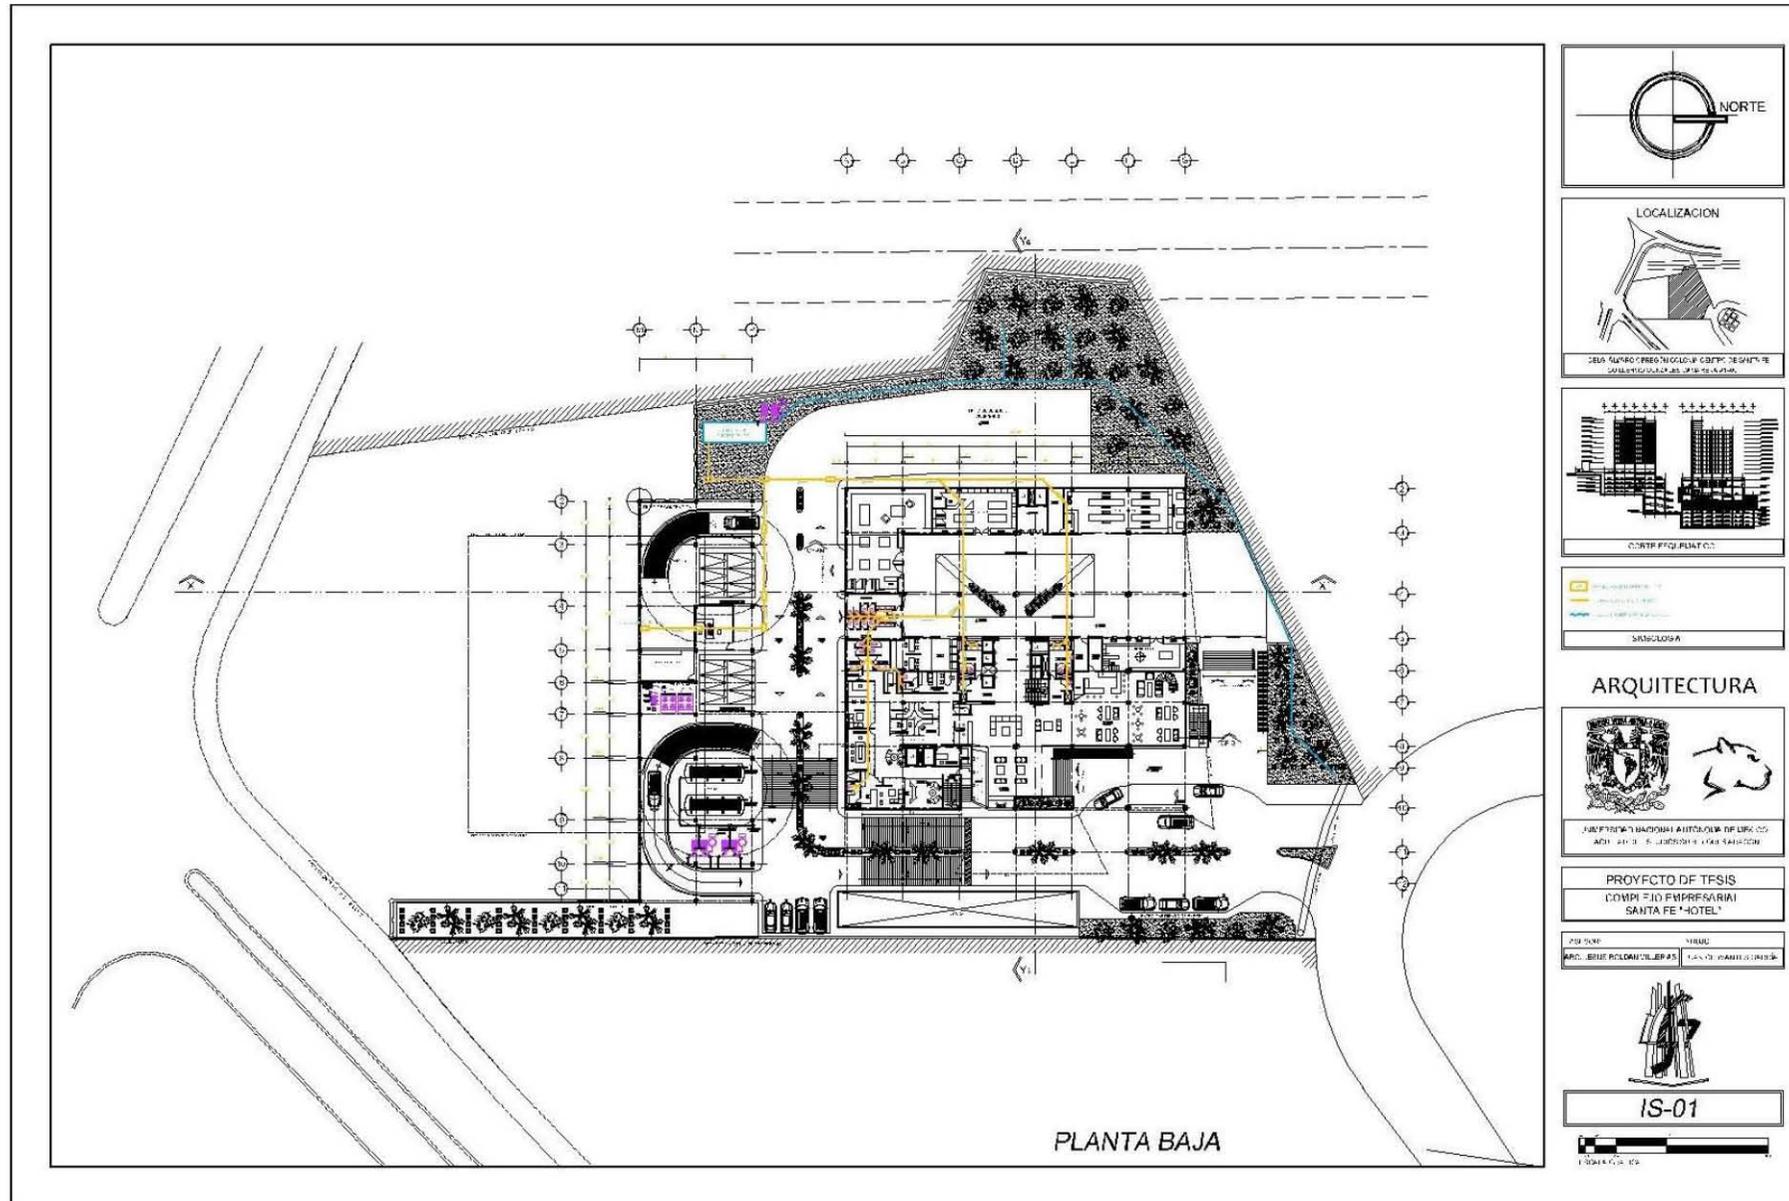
Plano IS-01; Plano instalación sanitaria en Planta Baja. Edición propia.
